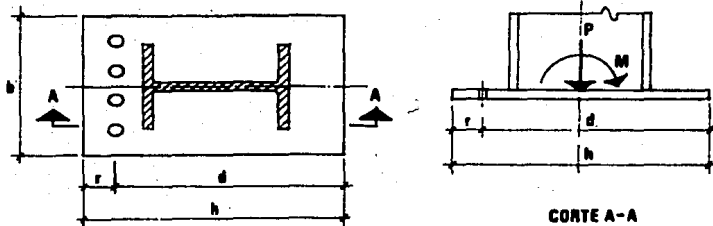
DIMENSIONES DE LA PLACA DE BASE.
